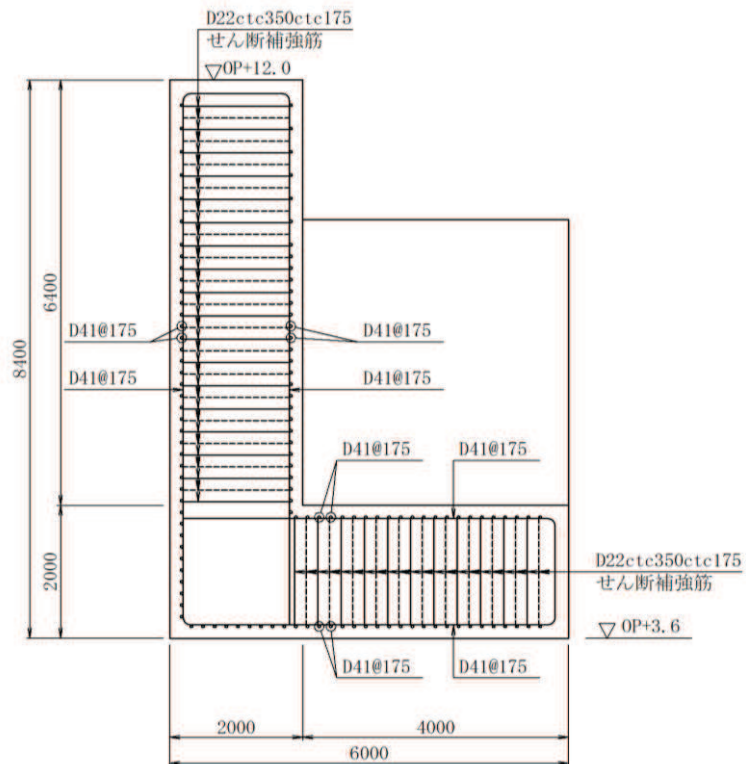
出口側集水ピット概略配筋図 (単位: mm)
